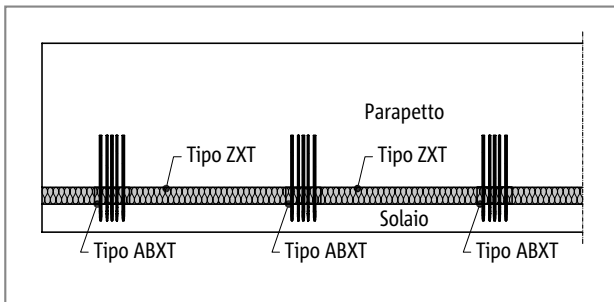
Schöck Isokorb® tipo ABXT - disposizione verticale, parapetto sovrapposto
